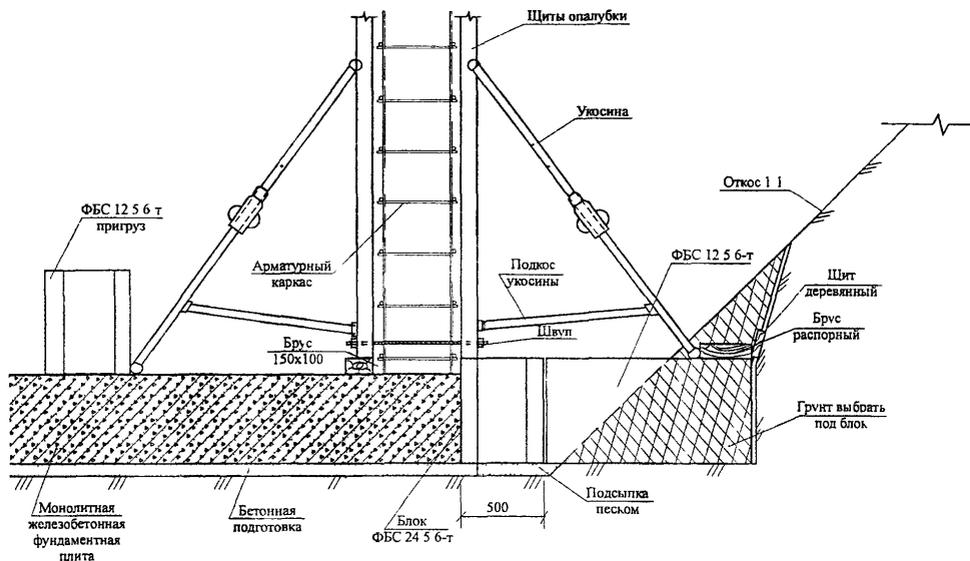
Схема крепления крупнощитовой опалубки стены
